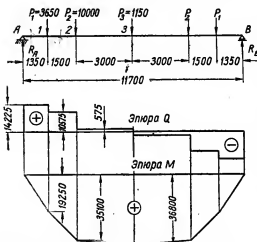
Расчетная схема балки, схема нагрузок и эпюры расчетных усилий.
